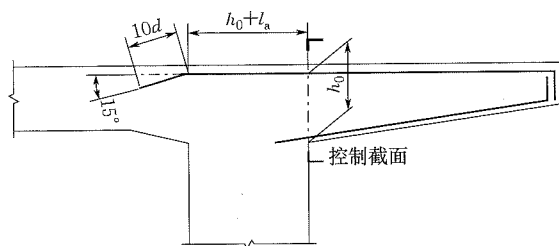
悬臂混凝土板上层横向钢筋的锚固示意图
